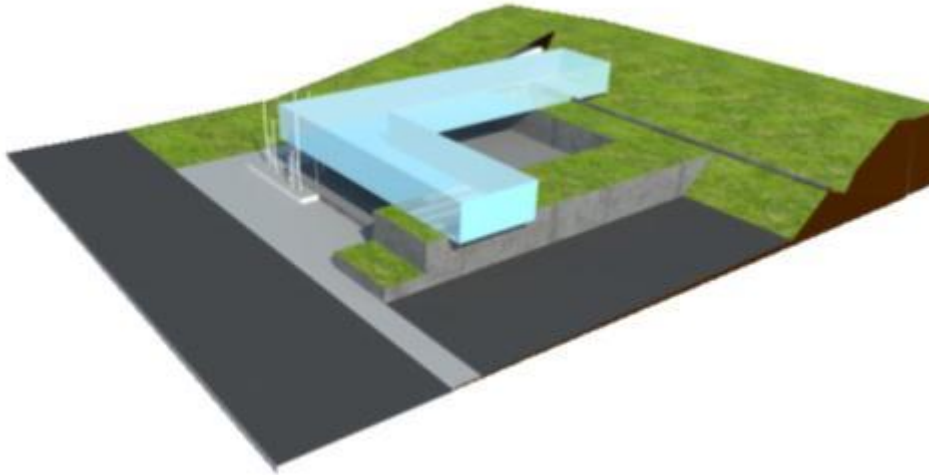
Centro Cultural El Tranque. Fuente: www.archdaily.pe
